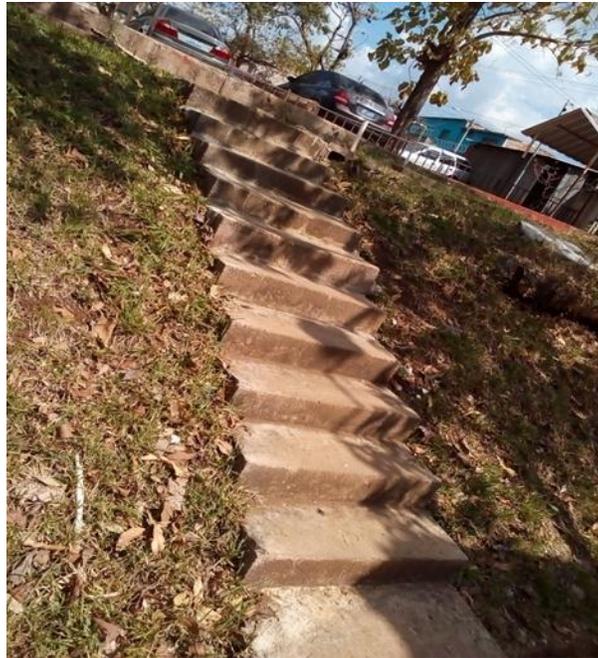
Escaleras situadas entre Almacén y pasillo hacia consulta externa.
